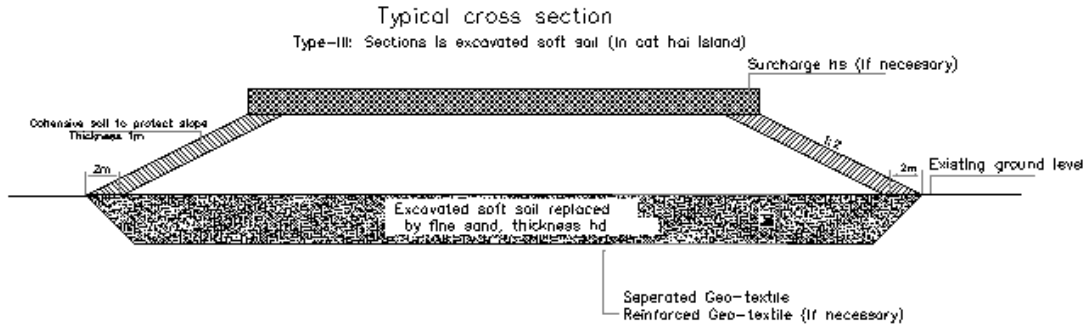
軟弱地盤対策工の標準断面図(置換え)
